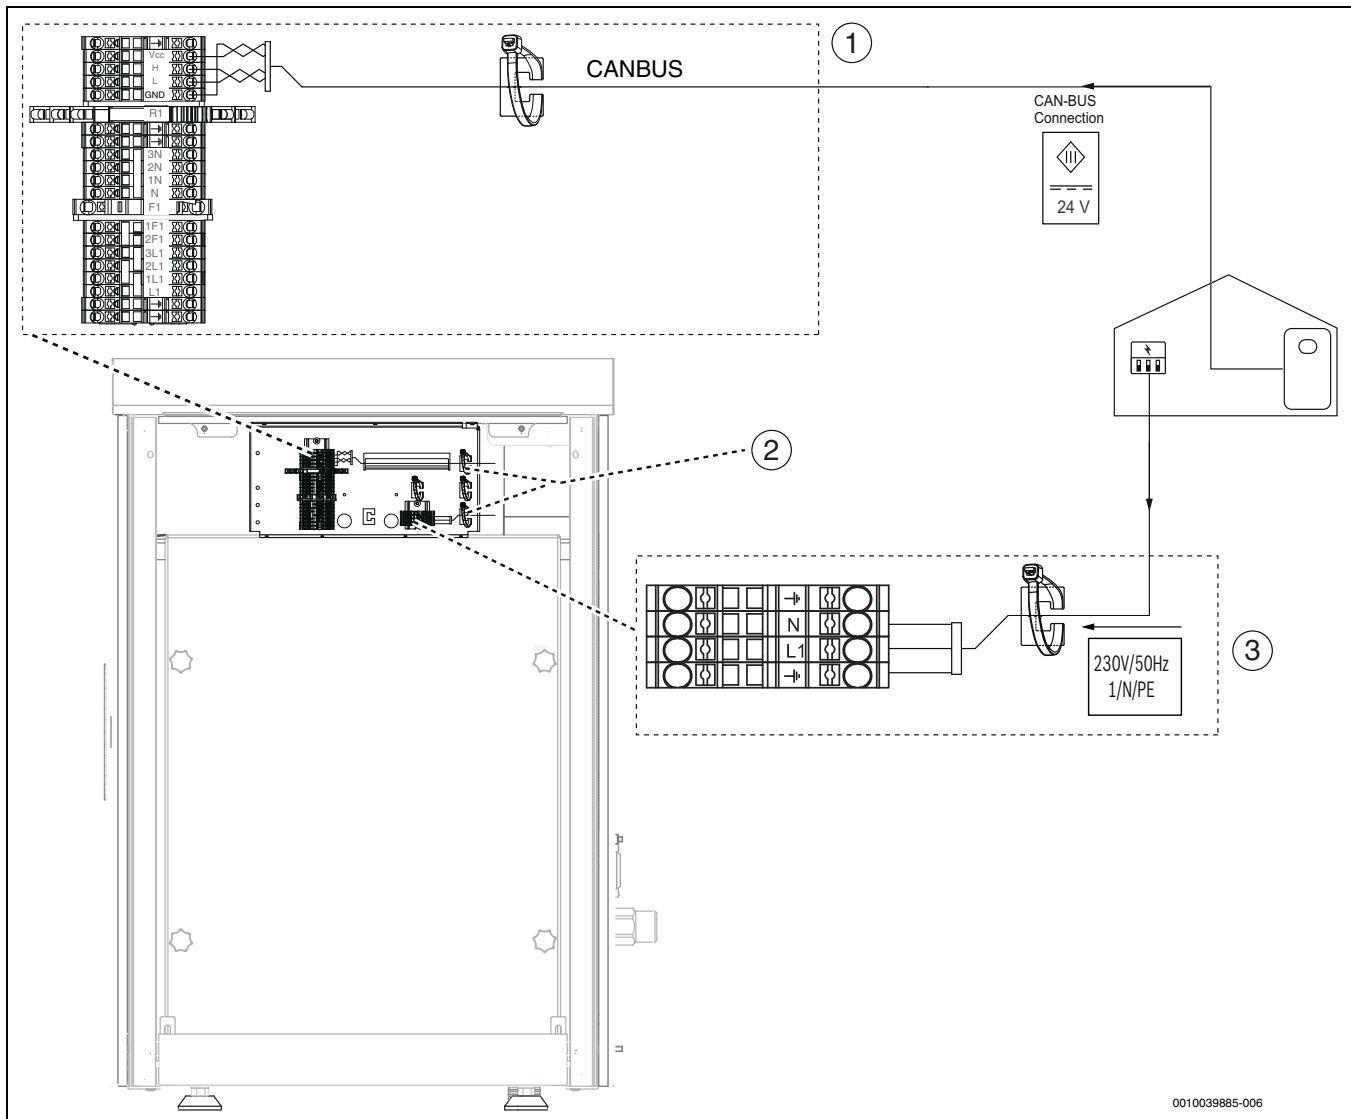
Anschlussklemmen am Installationsanschlussbereich
